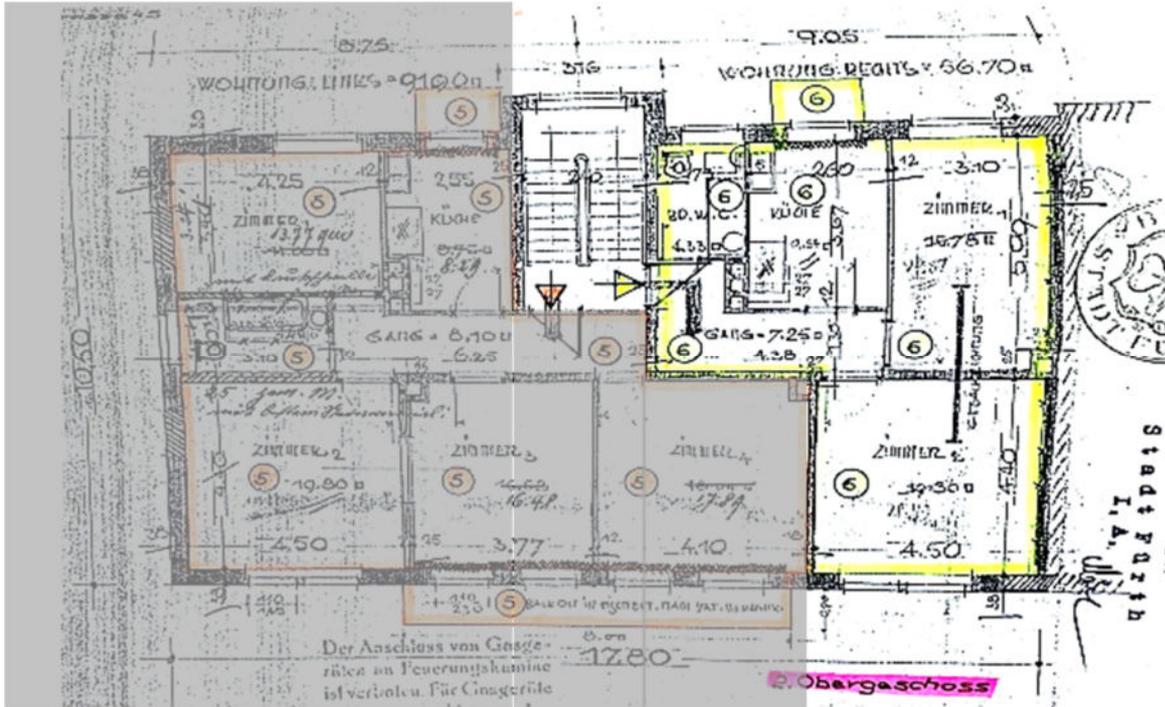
Grundriss der Wohnung Nr. 6
